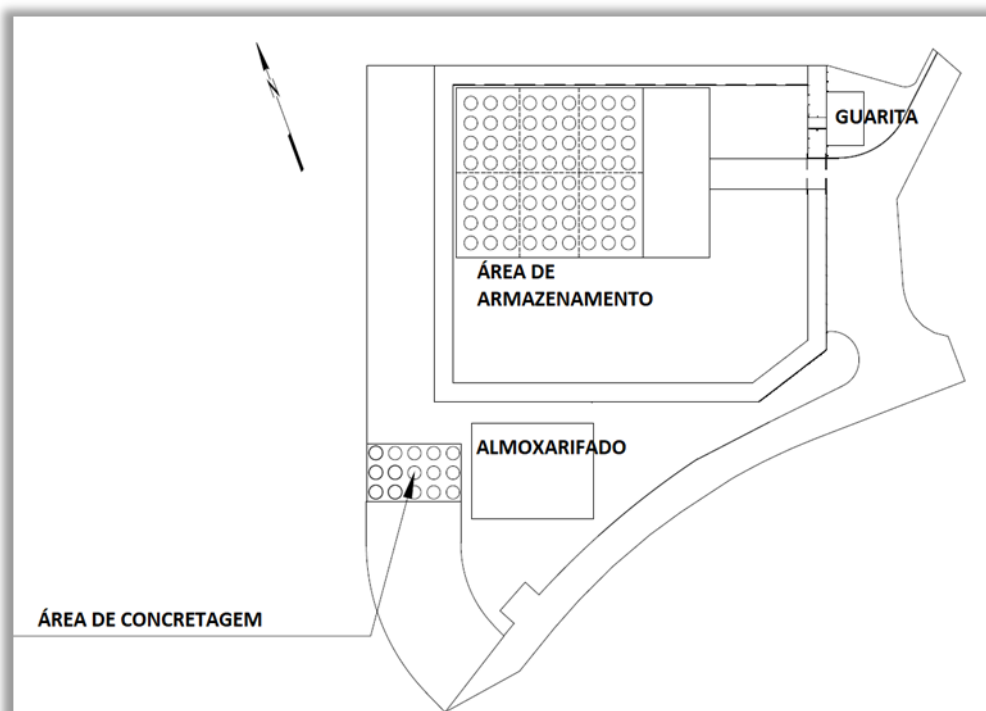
Layout da UAS com a inclusão da área de Concretagem.
